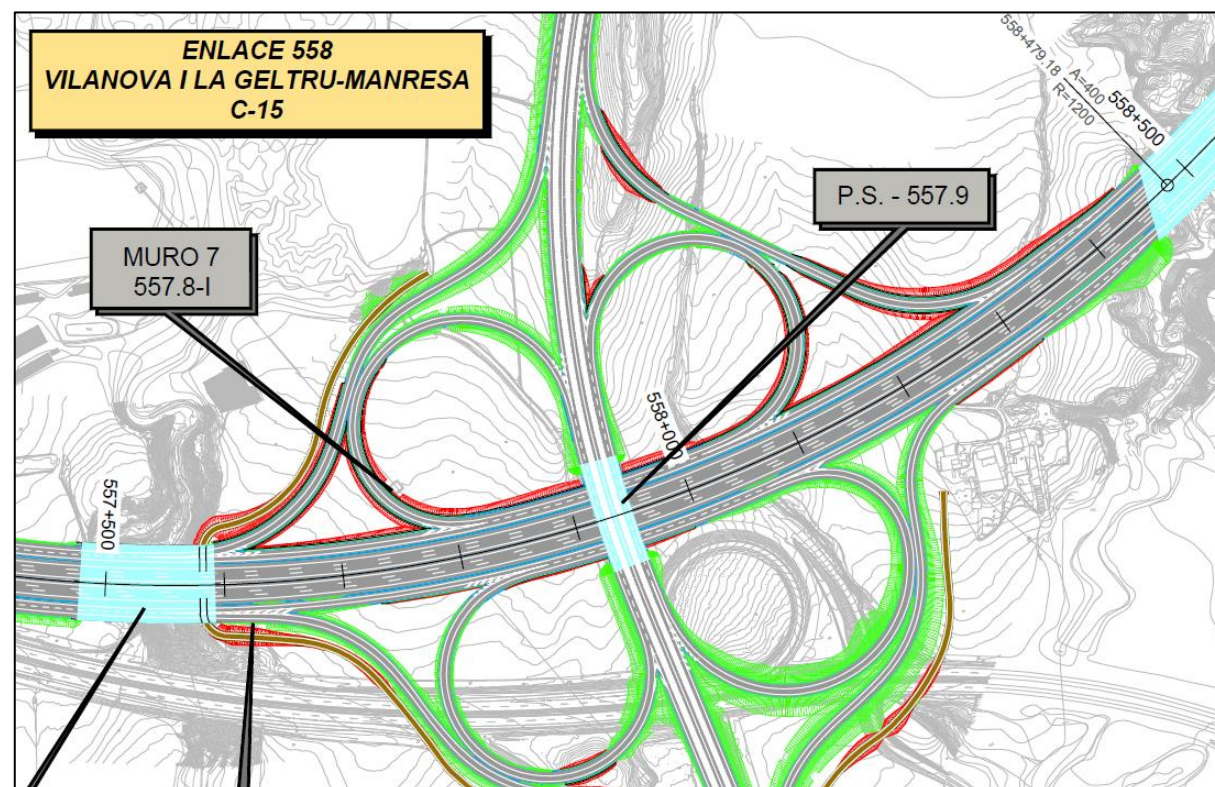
Enlace 558: Vilanova I La Geltrú – Manresa C-15.
